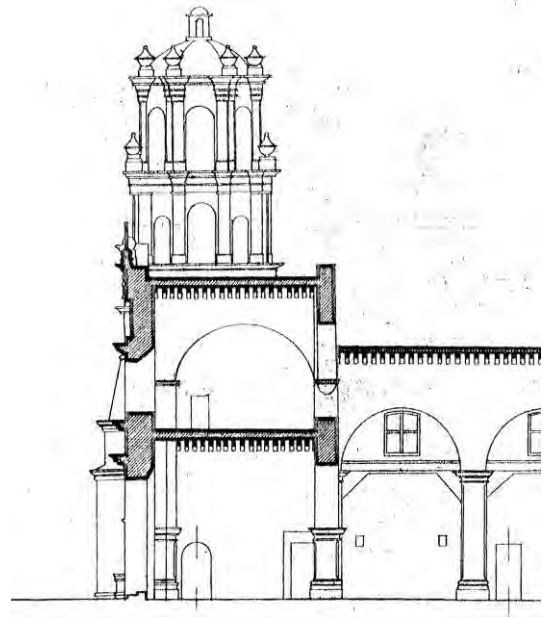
Disposición original de la vigería en 1923. Sección tomada del corte longitudinal.⁶³³
